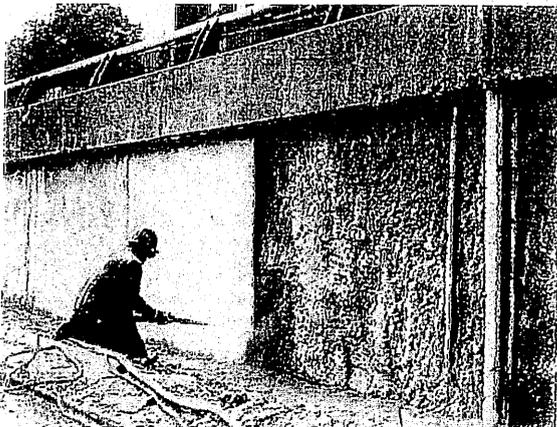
Sanierungsarbeiten an einer Stahlbetonstützwand
